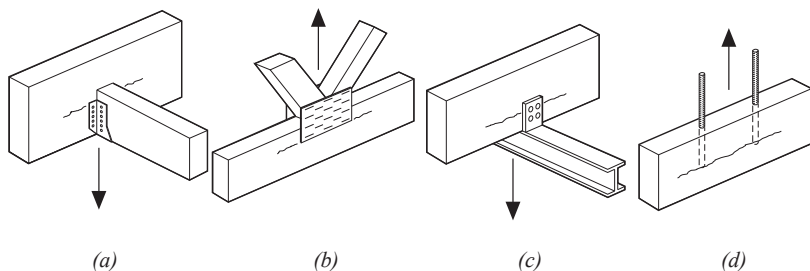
Beispiele von Queranschlüssen mit möglicher Rissausbreitung. (a) Balkenschuhanschlüsse (Stahlblech-Holz-Verbindung), (b) Nagelplattenanschlüsse, (c) Anschlüsse mit Stabdübeln oder Dübeln besonderer Bauart, (d) eingeklebte Gewindestangen. (STEP 1995 Beitrag C2)
